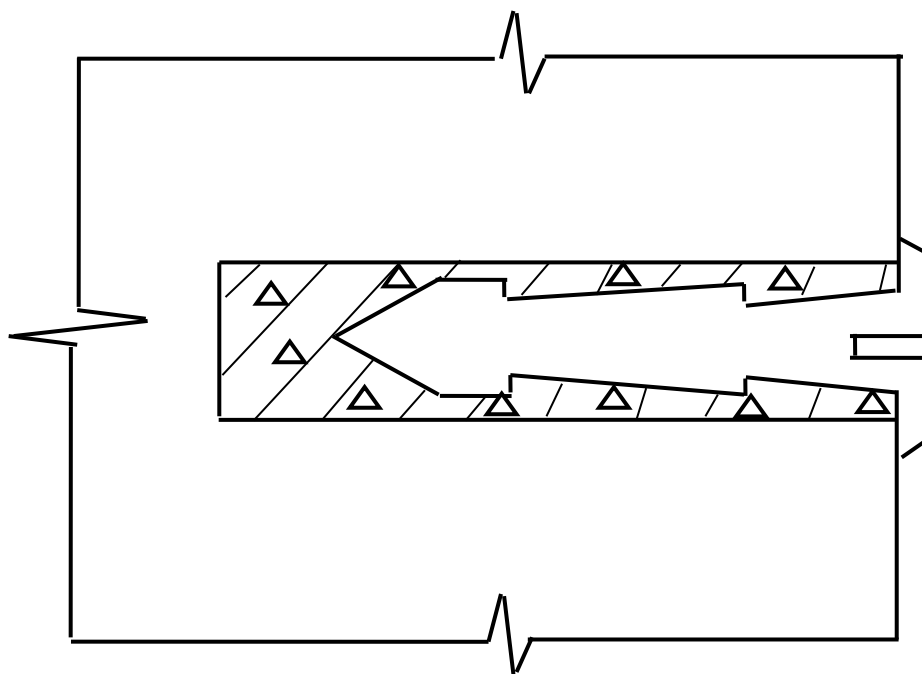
Закладка марок в фундаменты или стены зданий и сооружений
